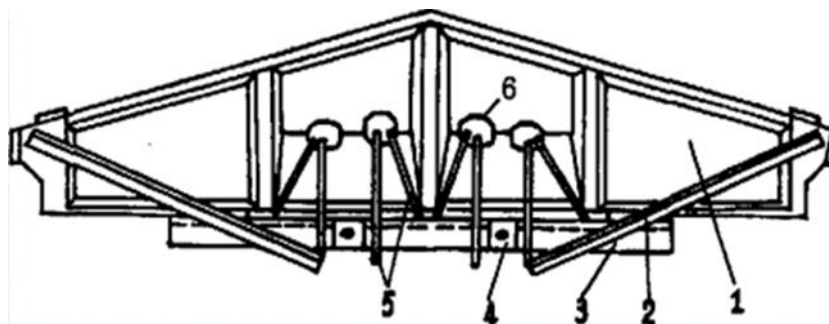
Усиление стропильной балки предварительно напряженным шпренгелем из уголков:
